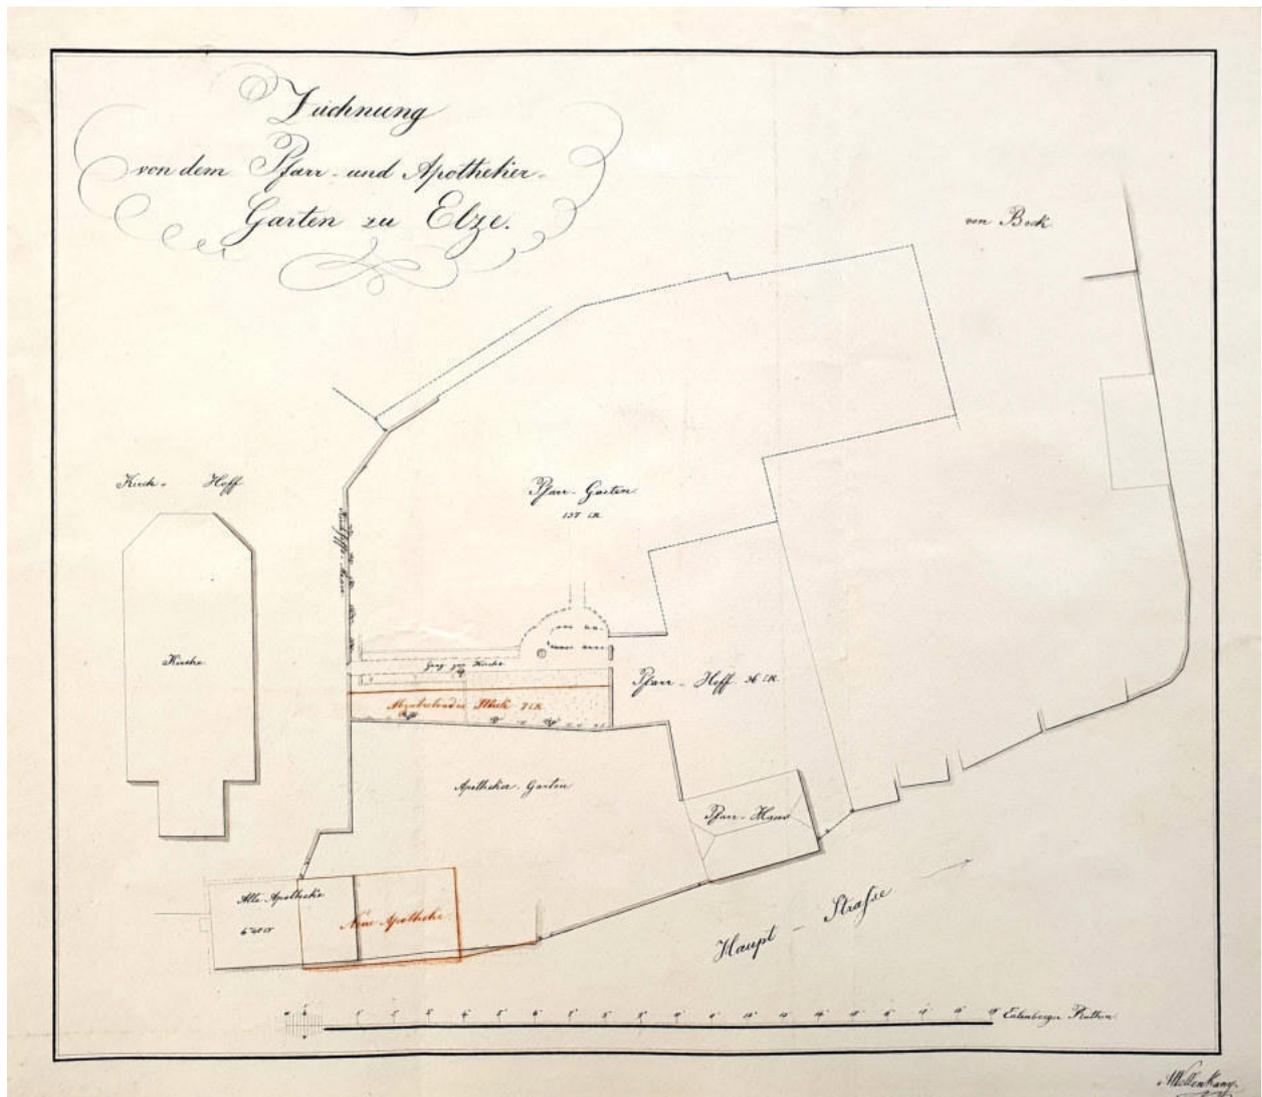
Lageplan „Zeichnung von dem Pfarr- und Apothekergarten zu Elze.“ (bez. Wellenkamp, wohl 1825). Der Plan verzeichnet den alten sowie neuen Standort des Apothekengebäudes und die östliche Grundstückserweiterung des Apothekengartens.
